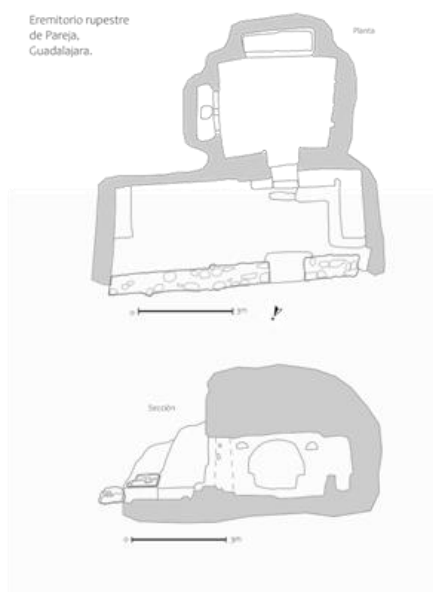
José Manuel Vallejo. Planta y sección del eremitorio rupestre de Pareja. Plano. 2021.
